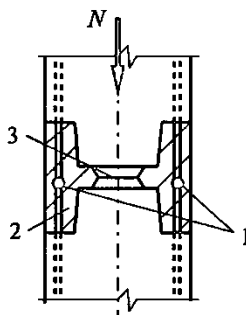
Стык колонн: 1 — ванная сварка; 2 — бетон на мелком щебне;
